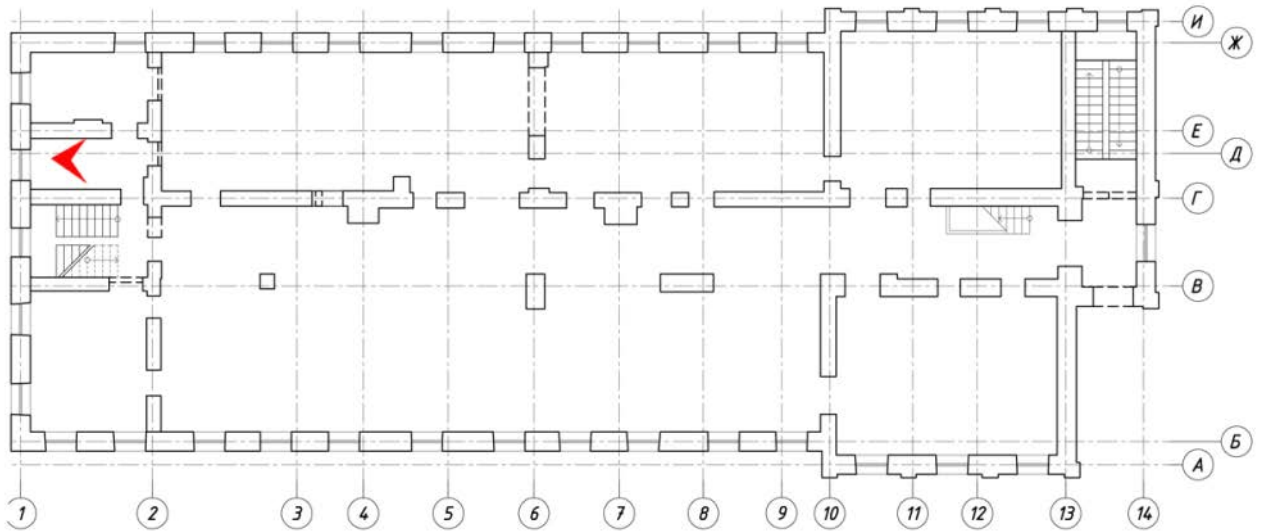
Помещение 2-го этажа в осях 1 – 2/Г – Е.
